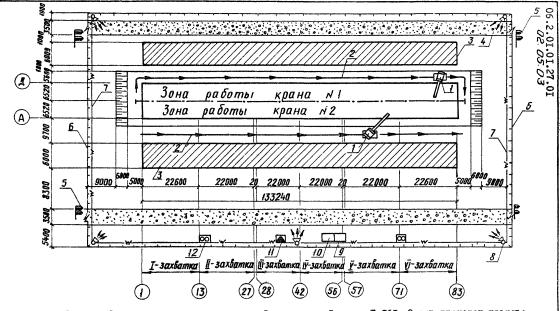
Рис. I. Схема организации строительной площадки: I-краны К-161; 2-оси проходок кранов; 3-площадки складжрования материалов и конструкции: 4-временный проезд; 5-знаки: Берегись автомобия" и "Посторонии вкод воспремен; 6-временное ограждение; 7-кабель 380в; 8-пролектор-ная мачта; 9-бытовое помещение; 10-контора производетеля работ; II-грансформаторная подстан-IME KITH-T80: 12-Tyazet
